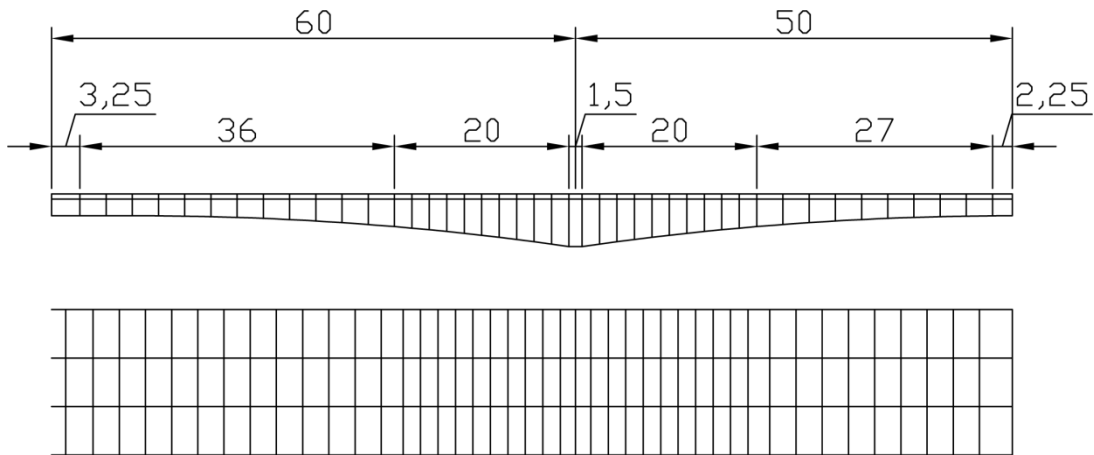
Rebanadas y emparrillado plano de la mitad del puente.
